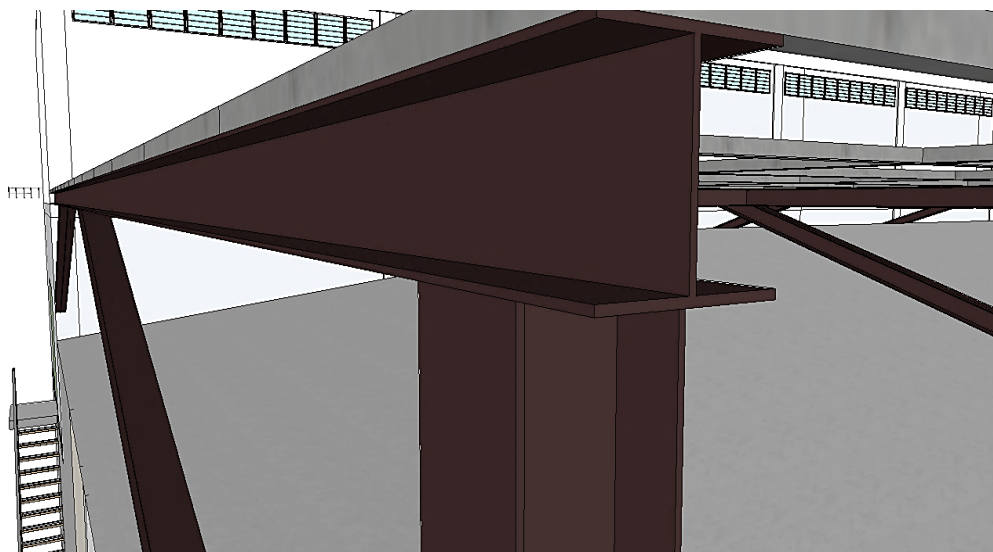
Detalle de junta de perfiles H (entre columna y viga).
